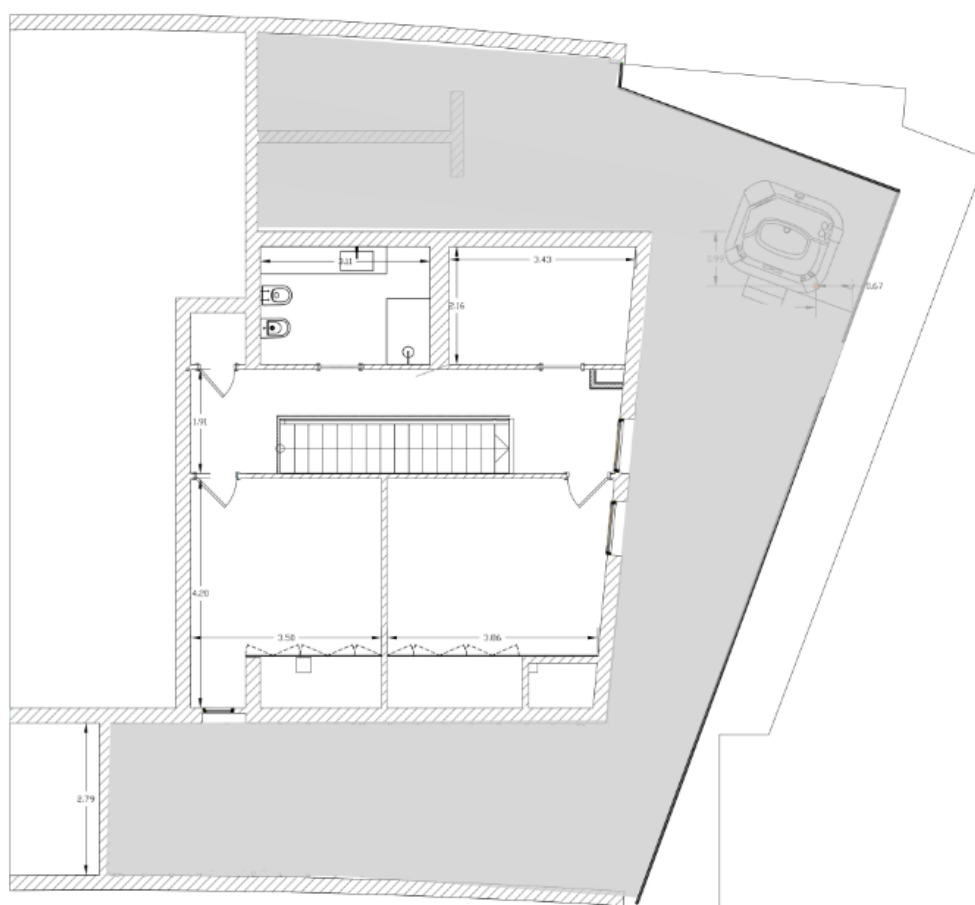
Planta Piso 1 | Terraço. Fonte: autora
